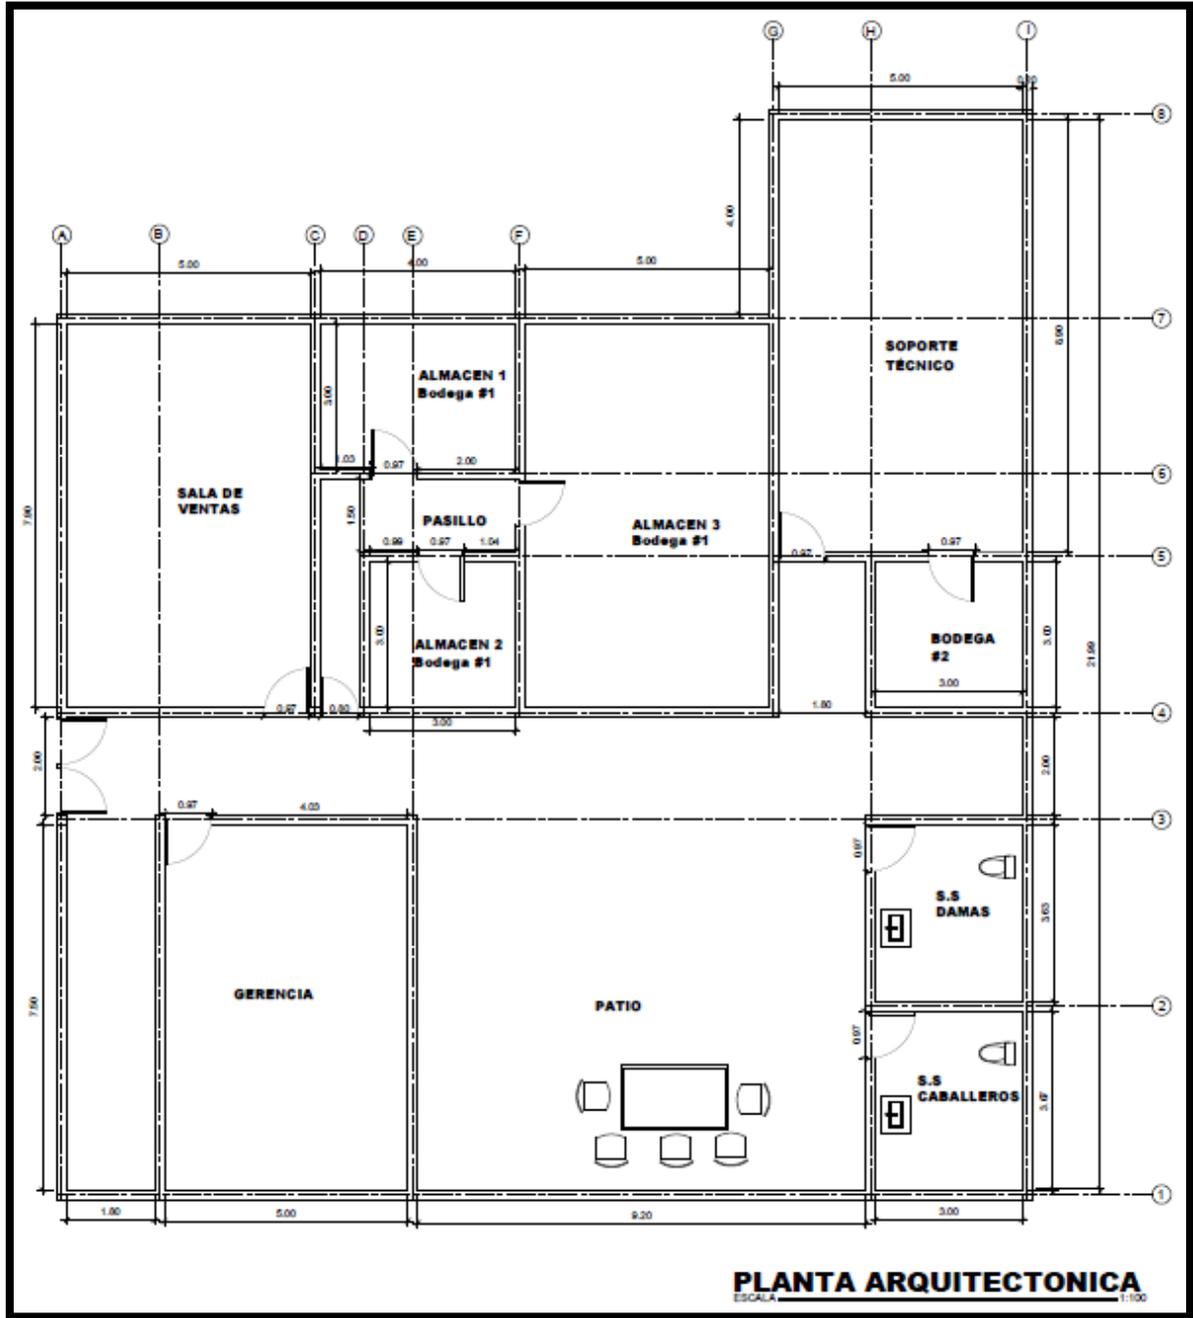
Planta arquitectónica del local<sup>42</sup>
